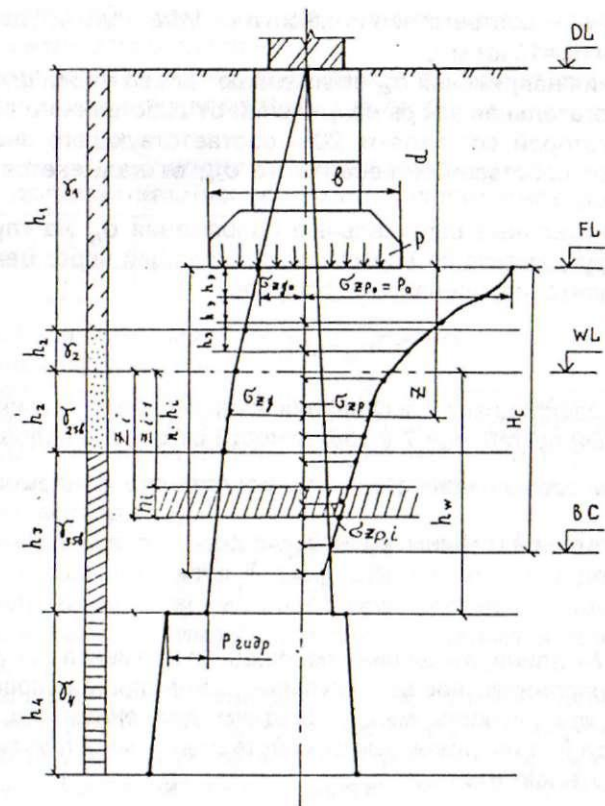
Схема к расчету осадки фундамента методом послойного суммирования:
